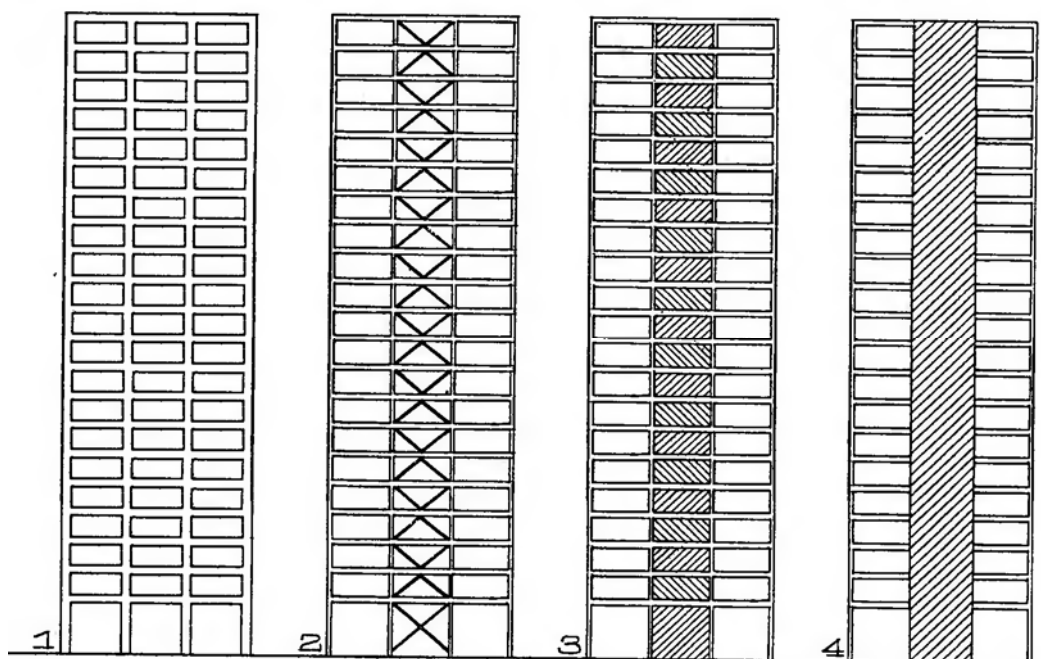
Основные механизмы придания вертикальной жесткости несущим конструкциям: 1 – неразрезные рамы; 2 – фахверковое соединение; 3 – сплошное заполнение каркаса; 4 – неразрезные стены
